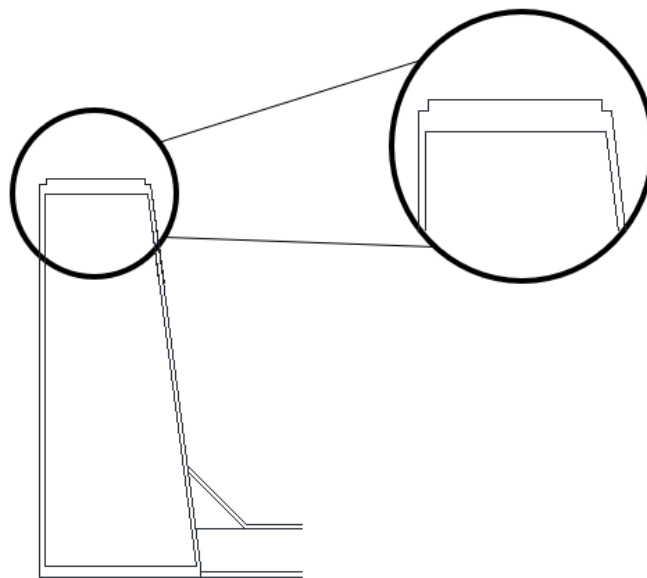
Pormenor do reforço estrutural na longarina lateral na zona dos apoios
